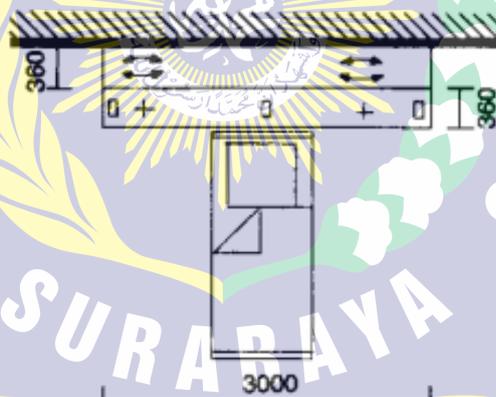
18 Ukuran Minimal Ruang Baca Perpustakaan
